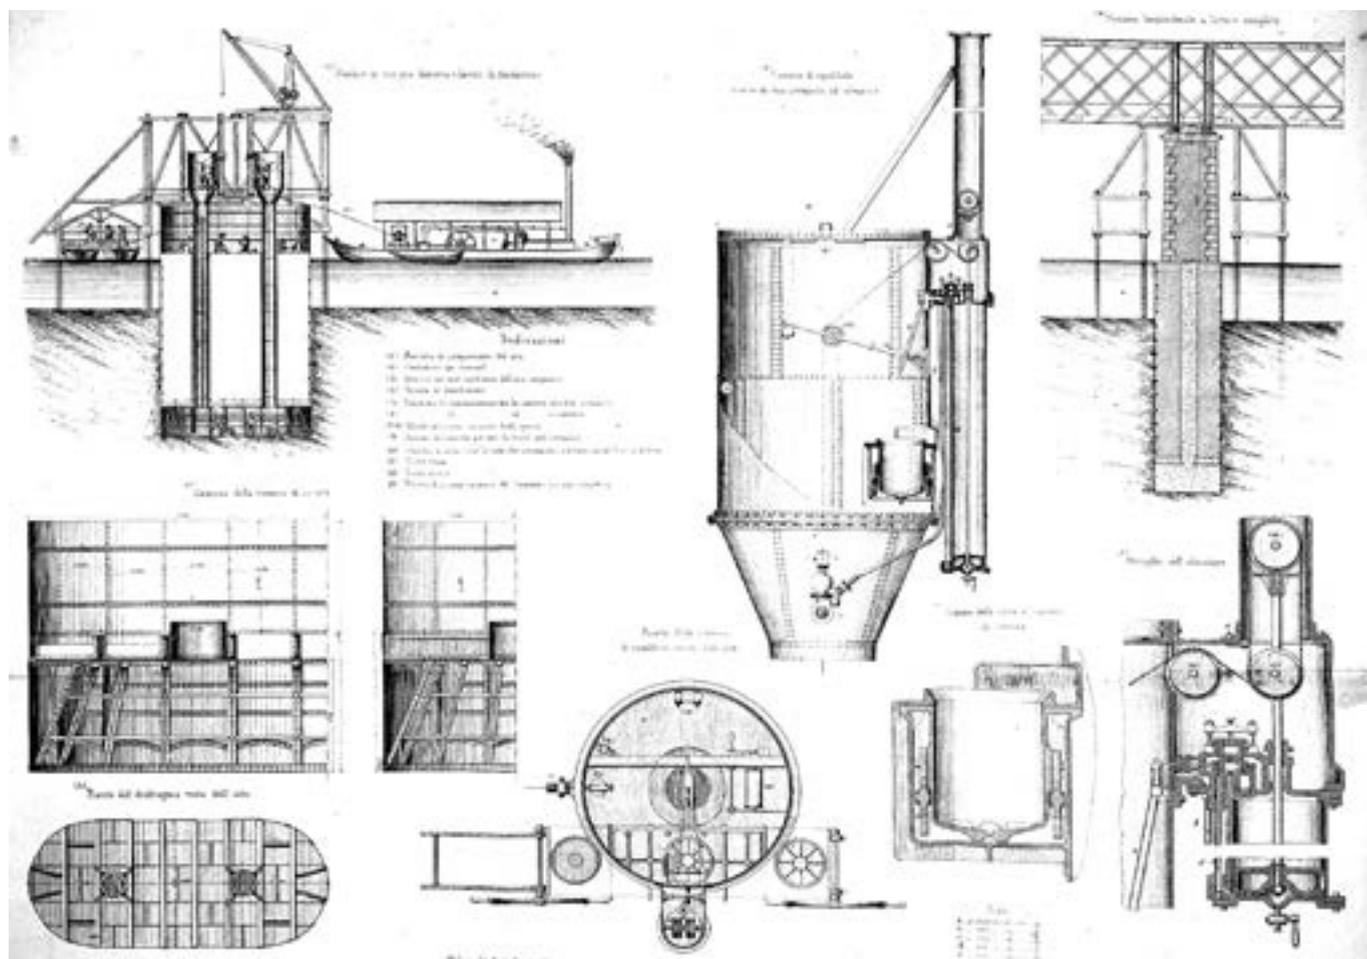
| Ponte a Pontelagoscuro: tavola illustrativa dell'affondamento del cassone e della camera di equilibrio progettata dall'ingegnere Moreaux (Ratti, 1876).
